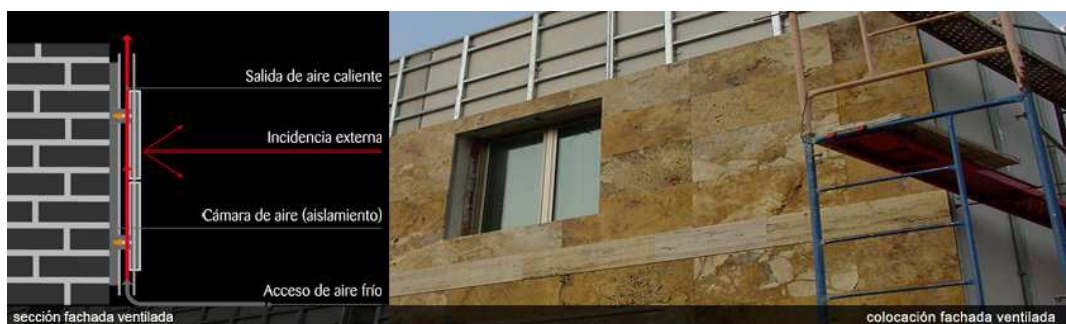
Sección explicativa del funcionamiento y la colocación de una fachada ventilada
